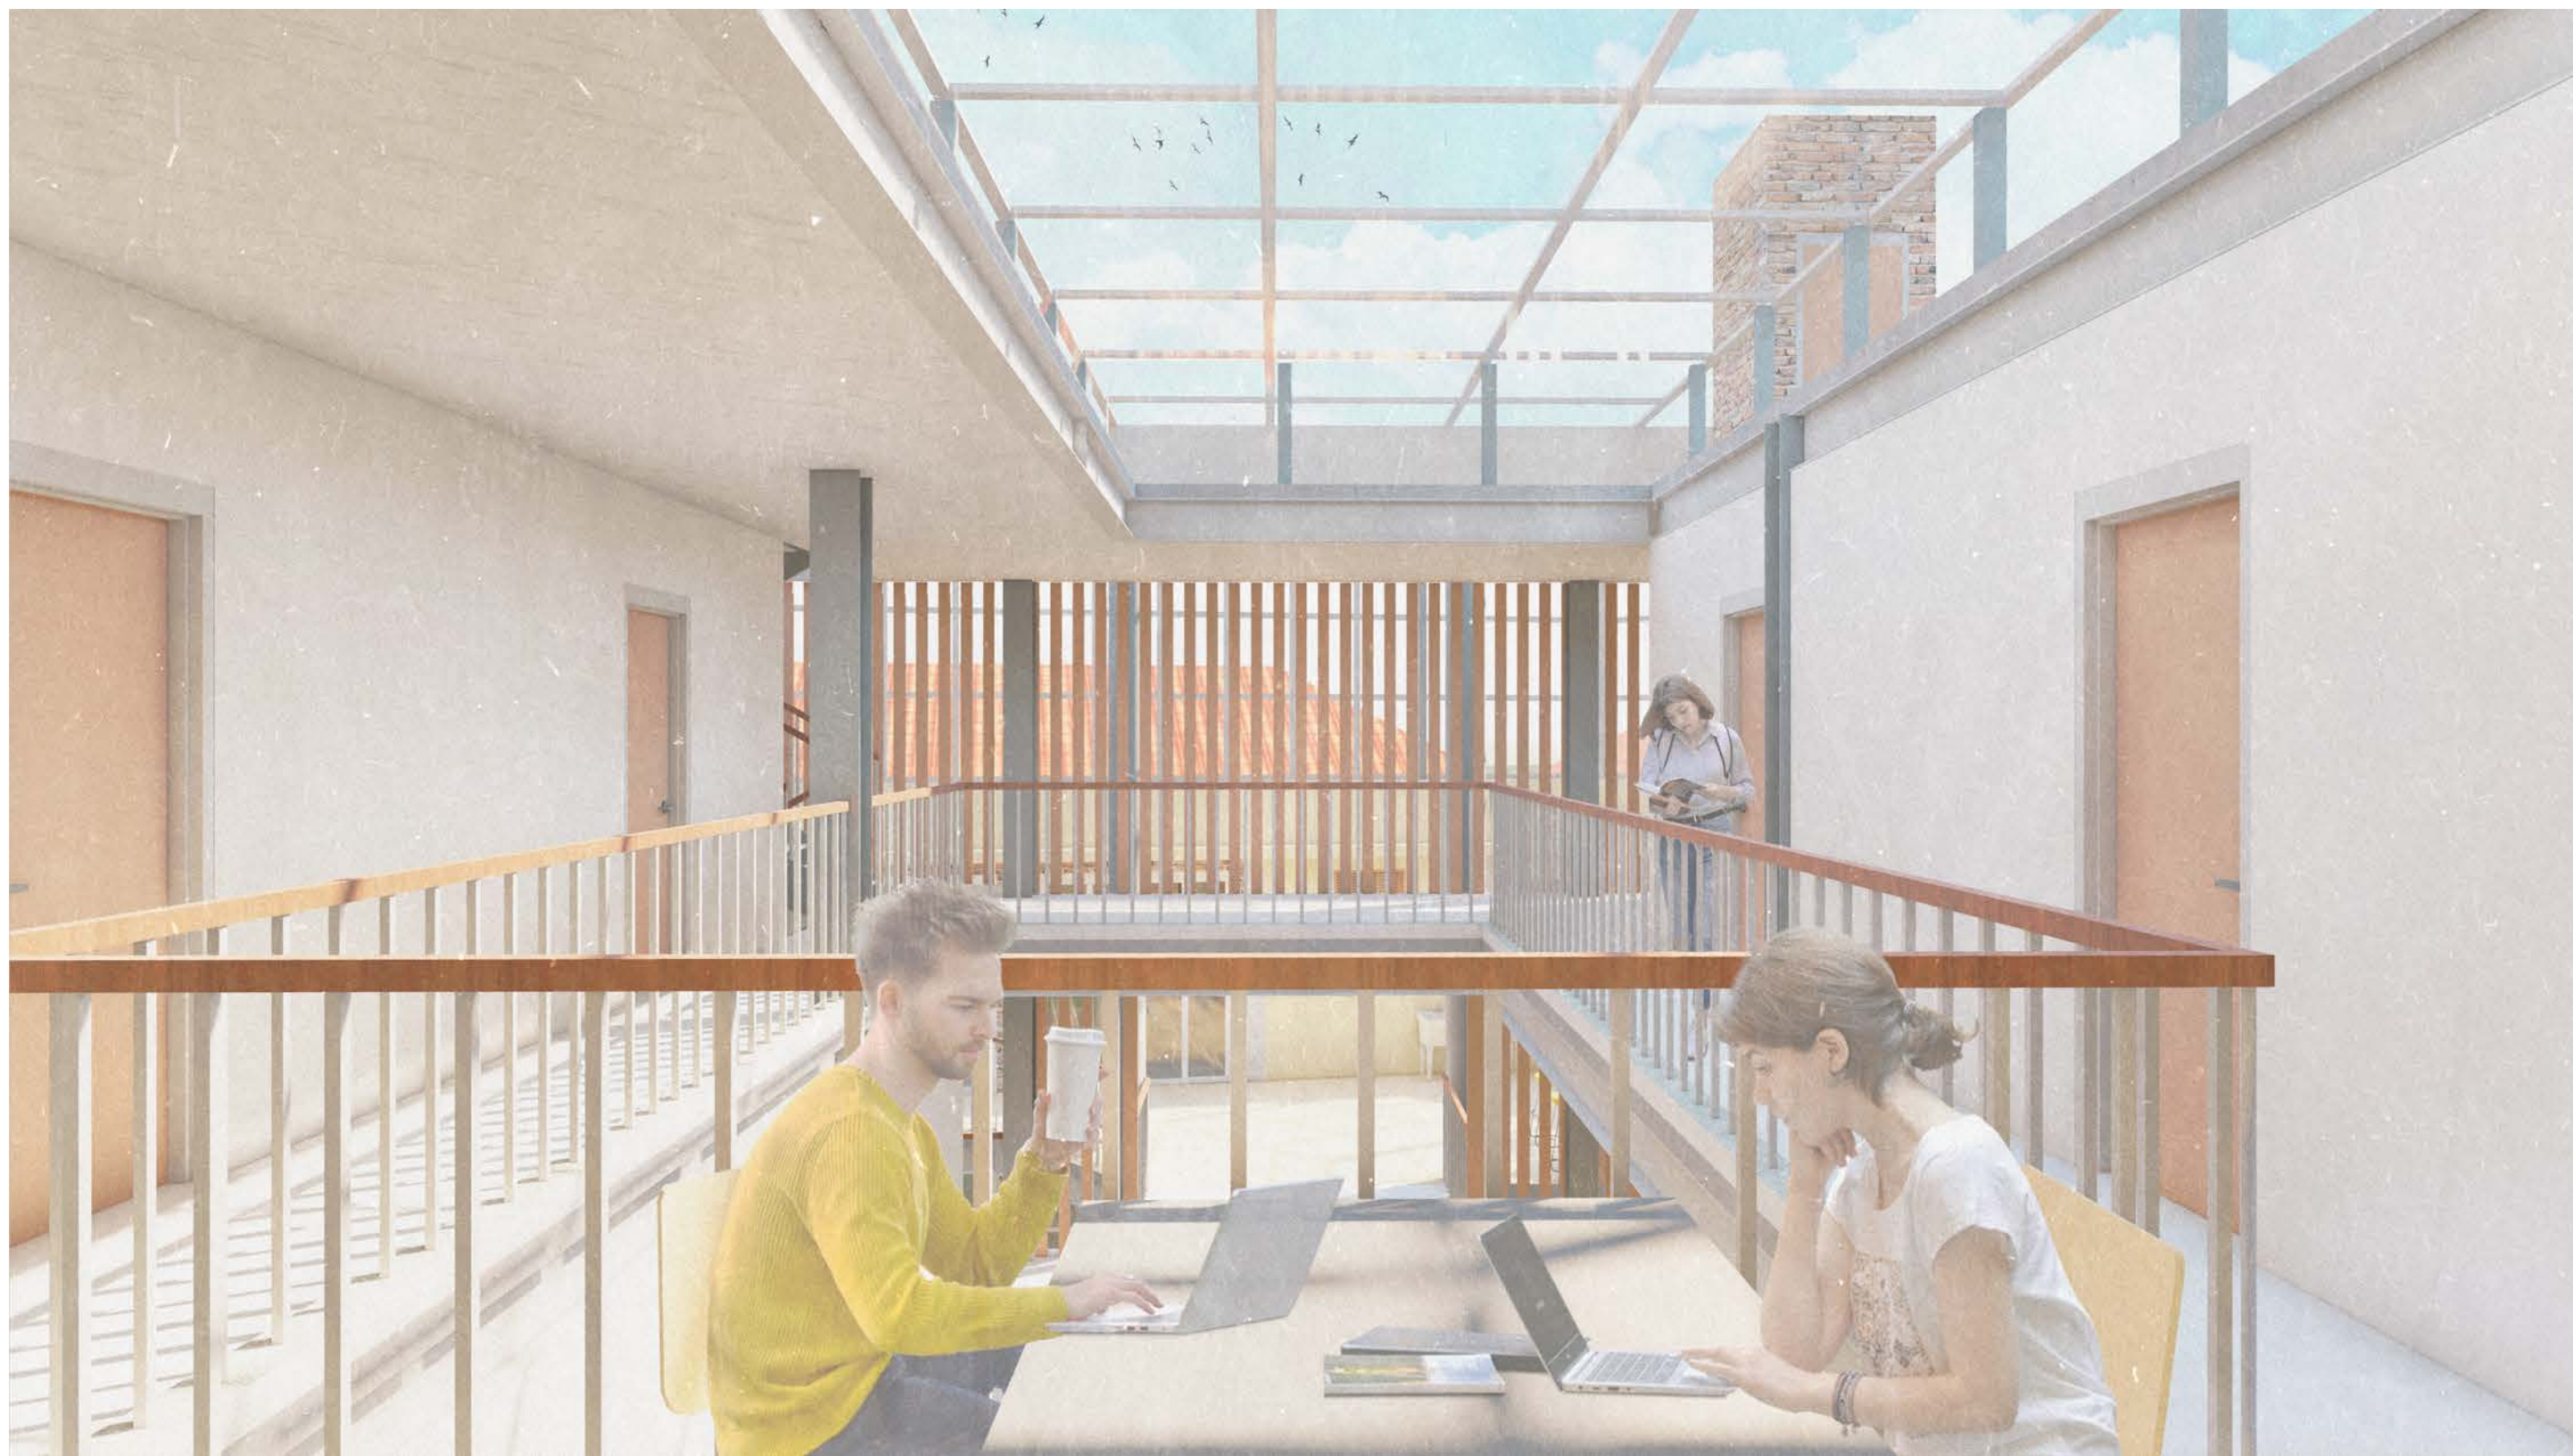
Vista a partir da cozinha no 3º pavimento da caixa.
